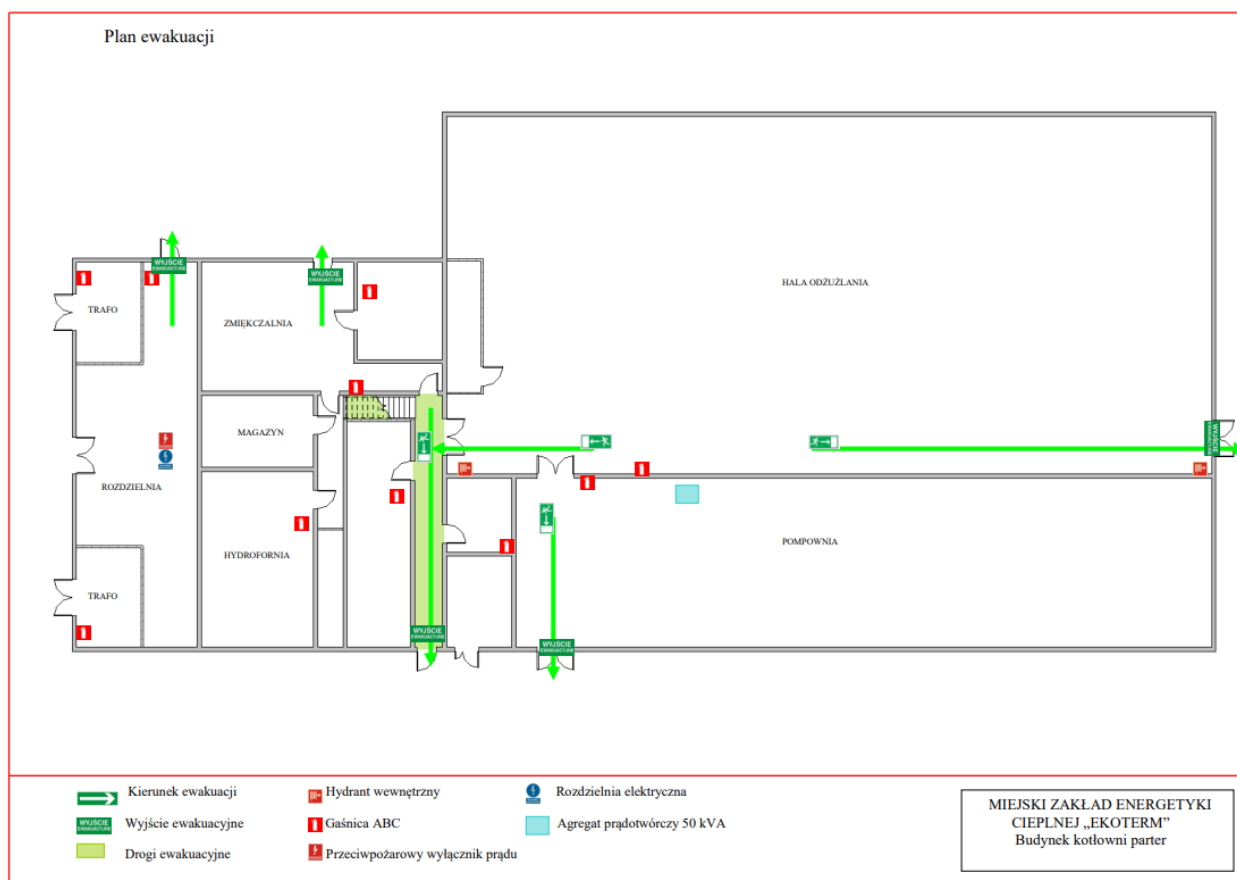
Plan ewakuacyjny budynku 1 kotłownia – piętro
